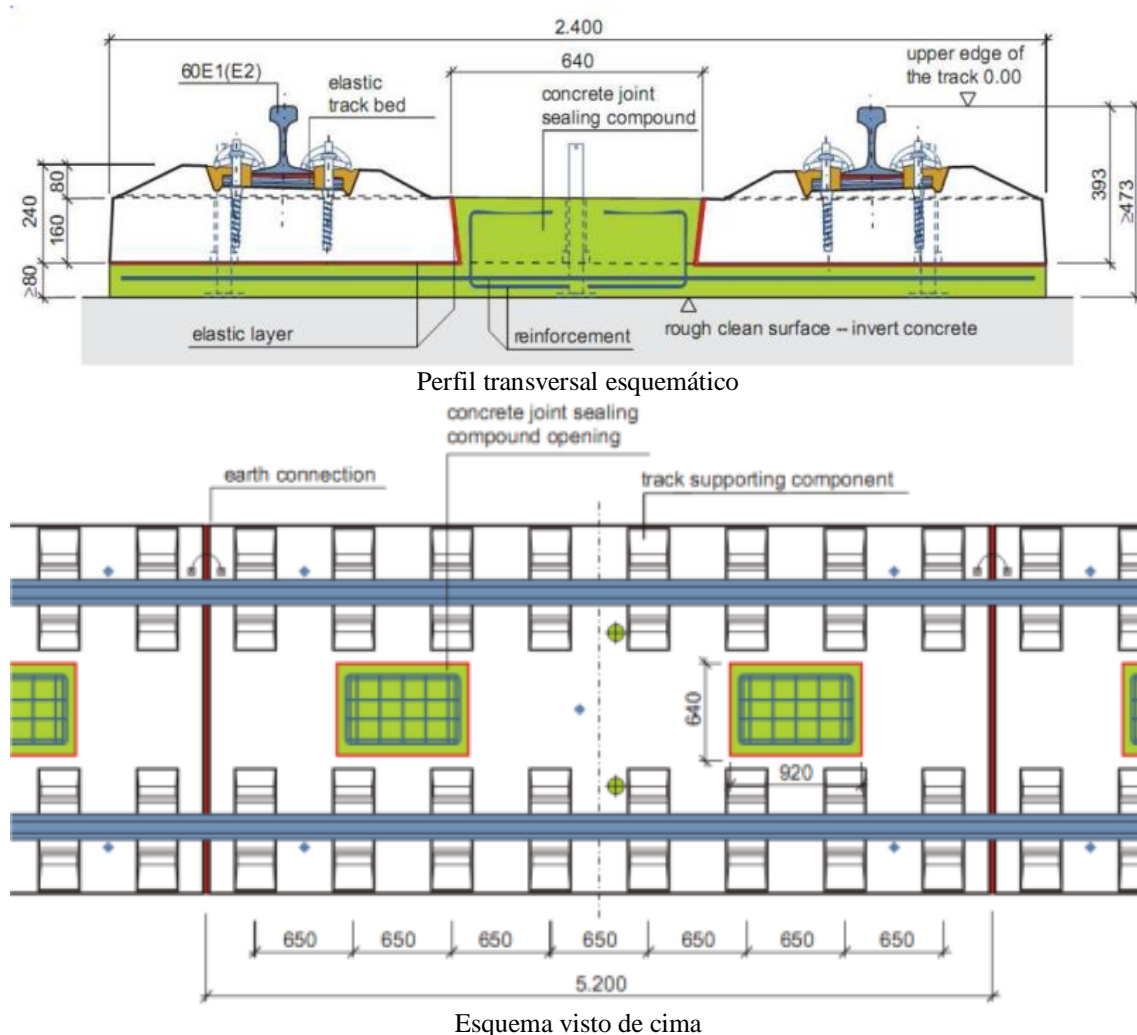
Esquema visto de cima e perfil transversal da laje ÖBB-Porr (Porr, 2006)
